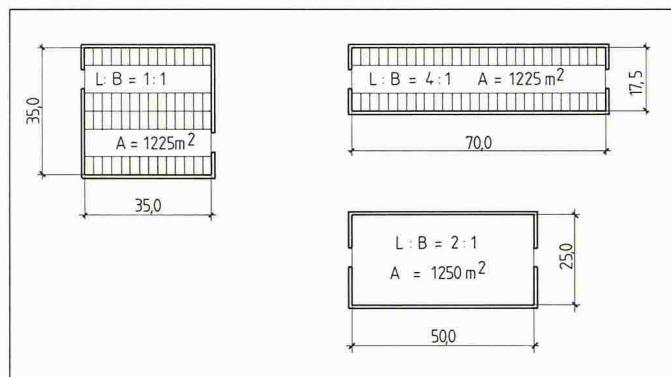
Die Parameterstudie für offen gebaute Parkhäuser umfasst neben den in Bild 2 dargestellten Grundrissen auch 3 Parkhäuser mit etwa gleicher Grundrissfläche, aber unterschiedlicher Geometrie
